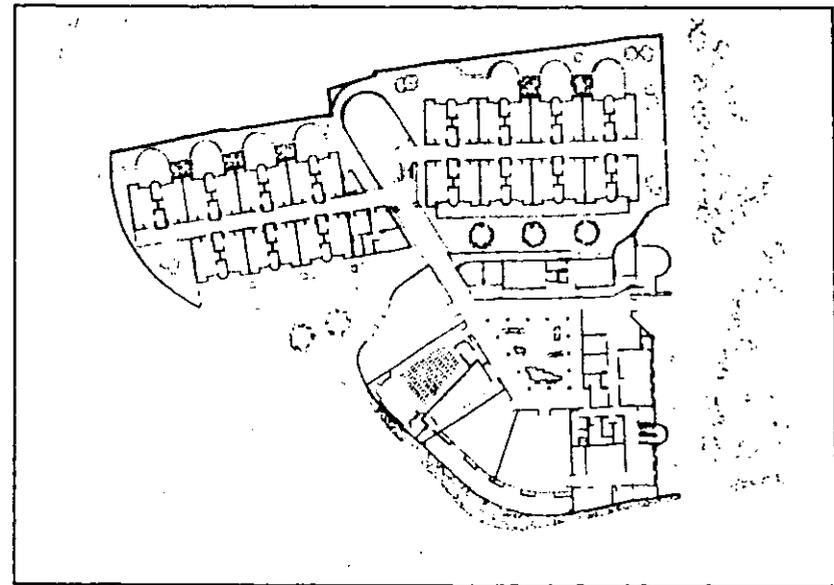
Planta arquitectónica de la Casa Hogar construida en la ciudad de Oaxaca. Obra concluida en el año 1989.
